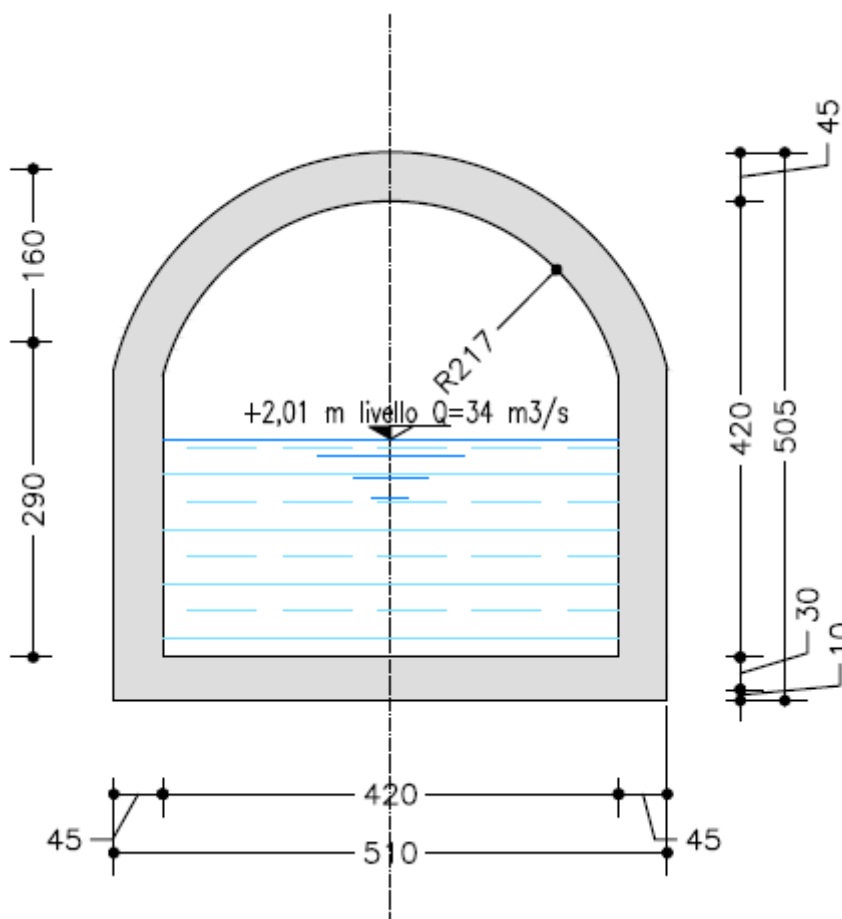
Estratto Tav. 7 - Sezione tipo galleria di derivazione.
